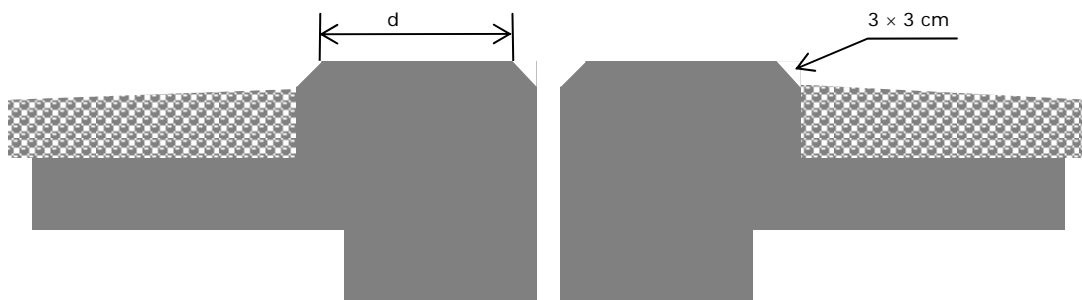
Coupe de principe de réservation d'un joint plat de toitures-terrasses accessibles aux piétons, avec une protection dure autre que par des dalles sur plots
